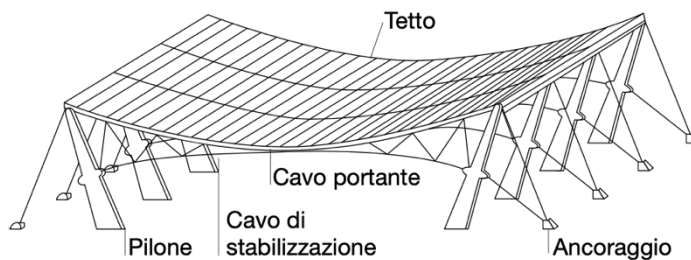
Travi di funi a sistema aperto con collegamenti inclinati
